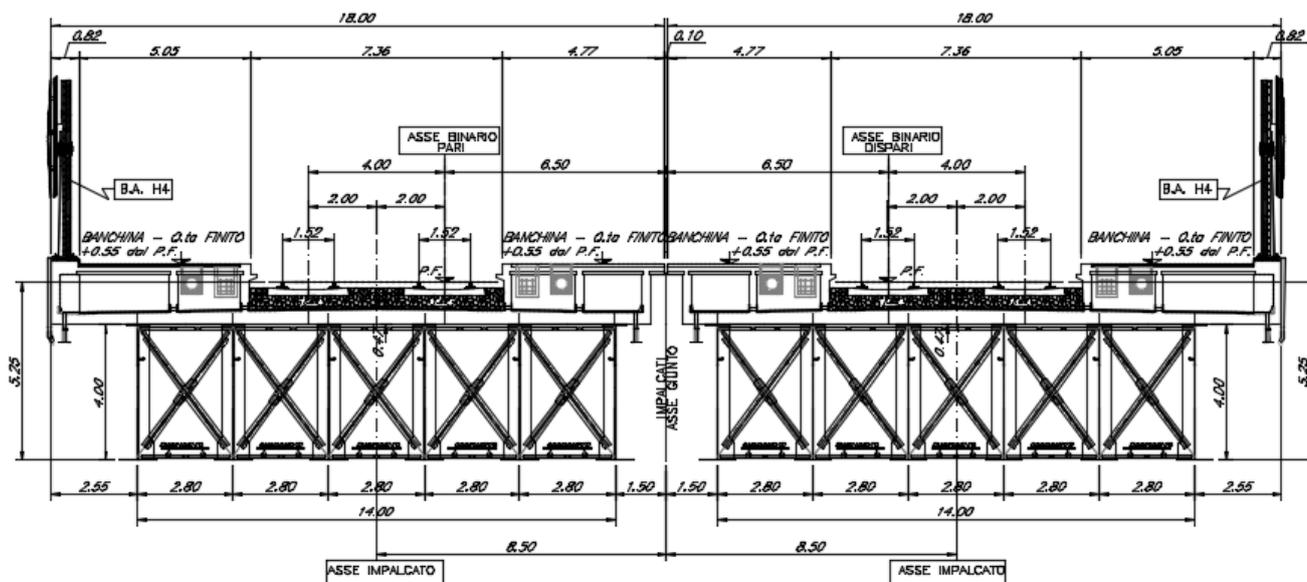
Viadotto fiumara d’Agrò: sezione trasversale
